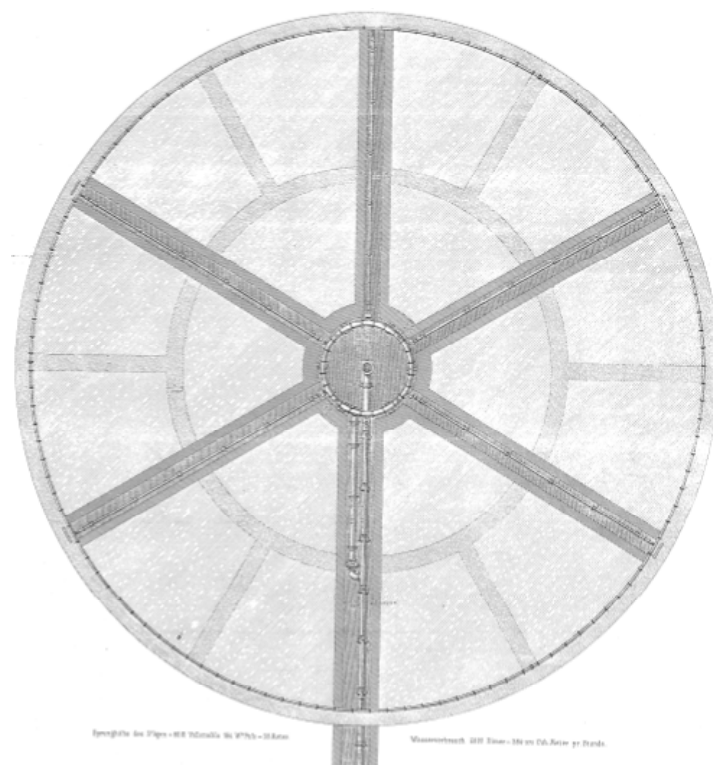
Grundriss des Hochstrahlbrunnens
